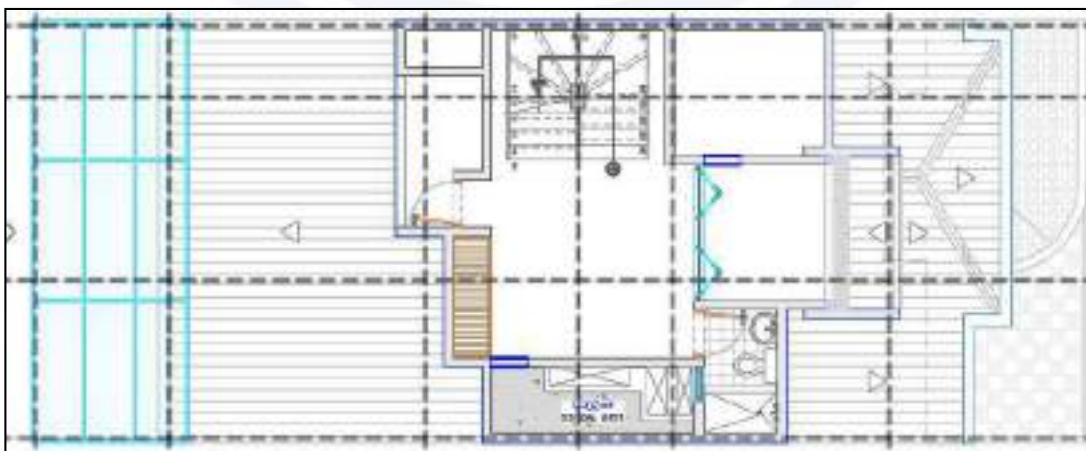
Preliminar Planta arquitectónica Nivel Cubierta
